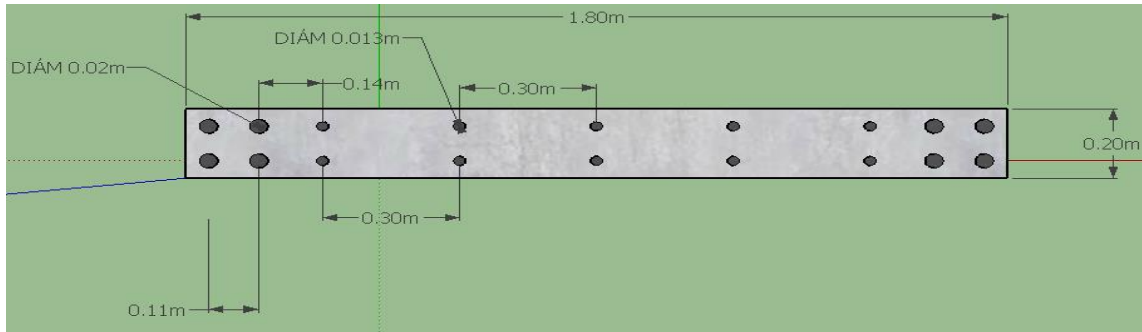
Muro de concreto reforzado – Corte transversal – Vista superior
